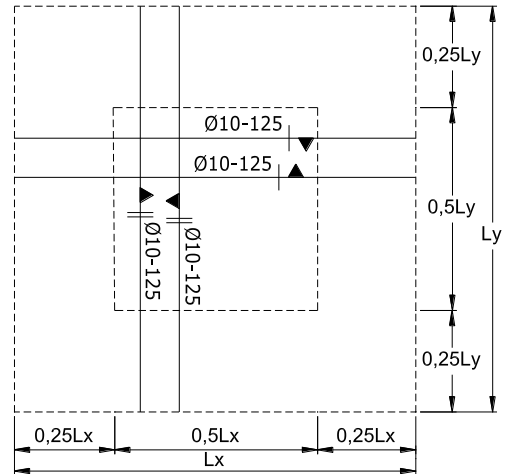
Denah Pelat Lantai SB Lantai Mezzanine yang Ditinjau
